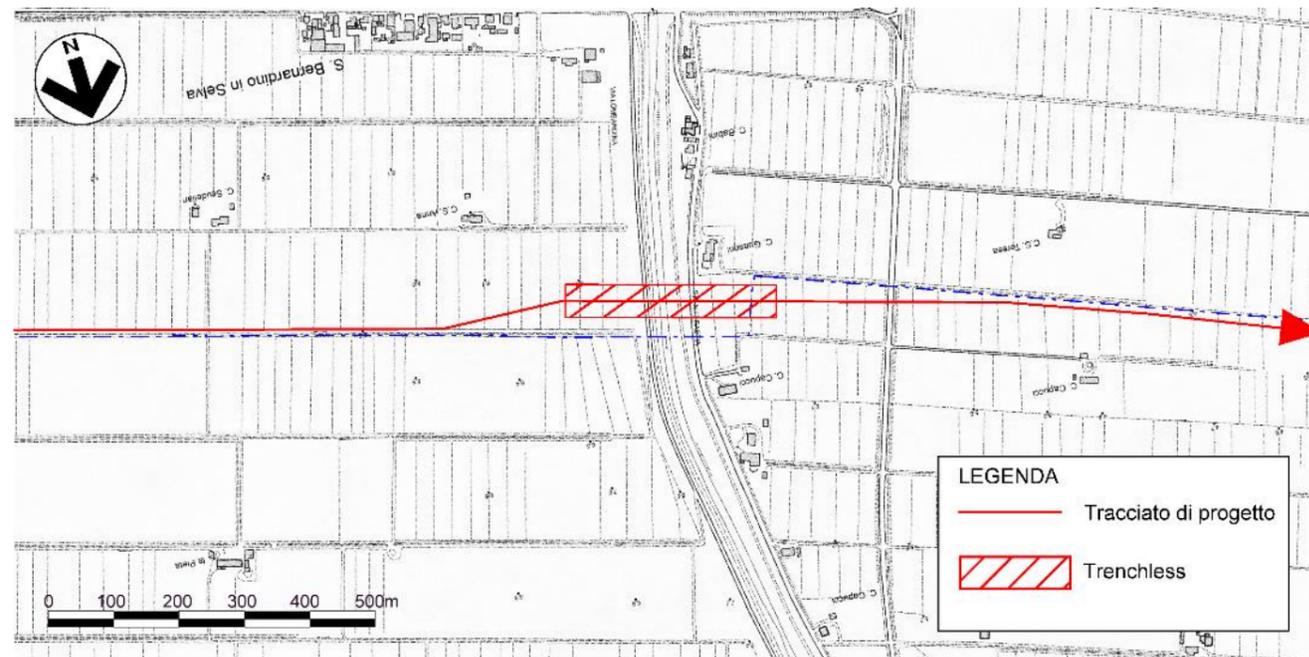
/A: Attraversamento trenchless F. Senio
